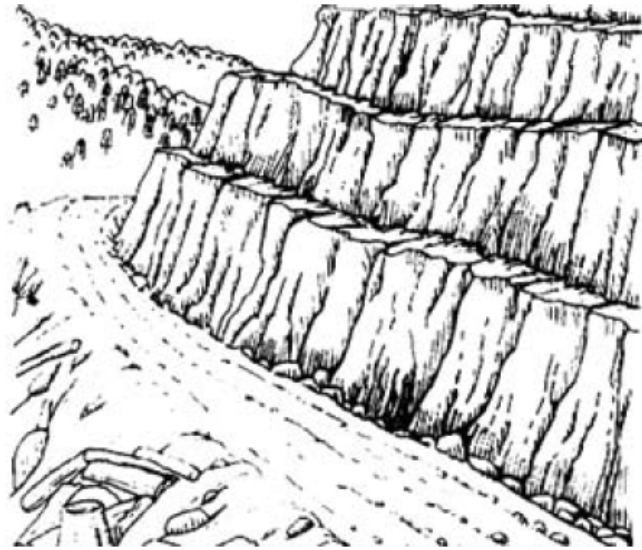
Desenho esquemático de banquetas (Highland & Bobrowsky, 2008).
